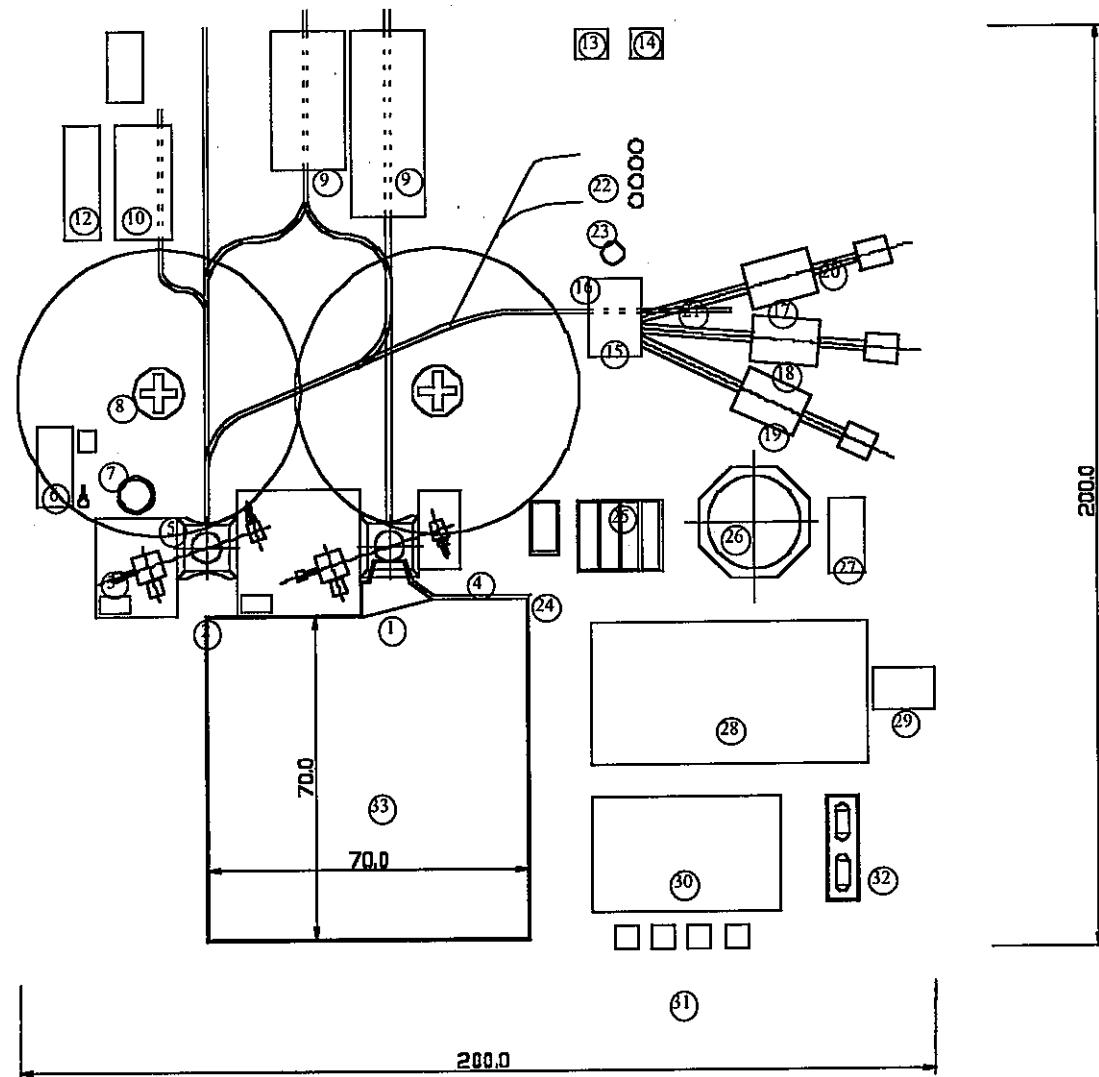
硬岩系岩盤における坑外設備の平面図
